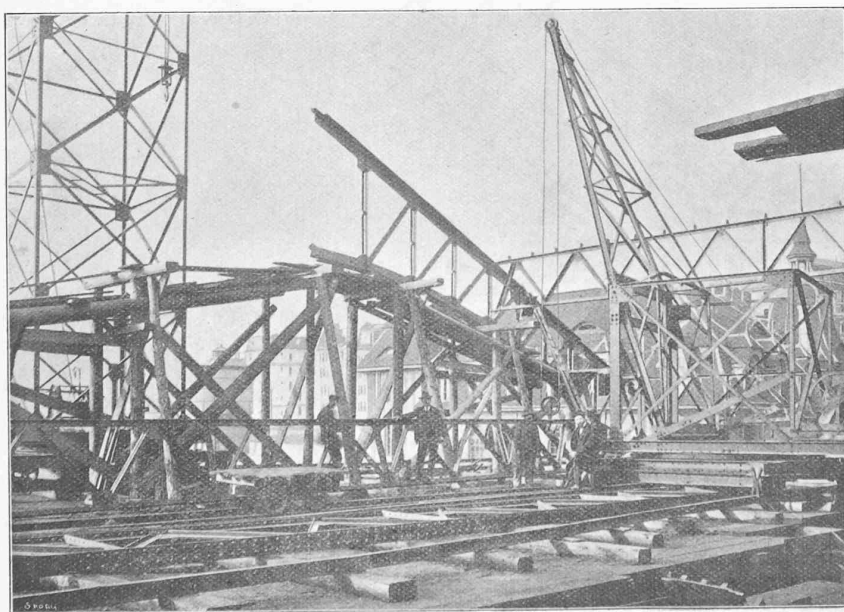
Vue du plancher de l'échafaud, au premier plan la grue basculante et pivotante.
